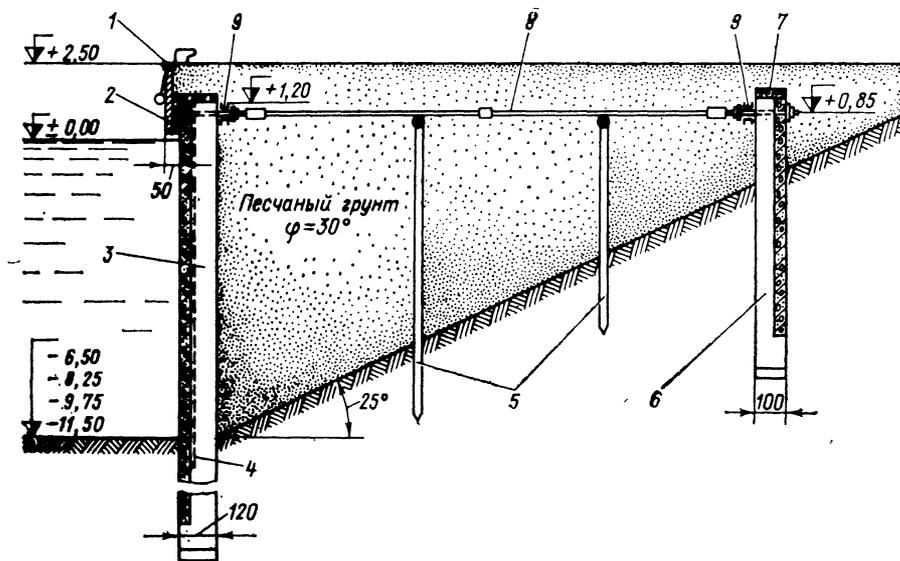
Больверк из железобетонного таврового шпунта для строительства в морских условиях:
